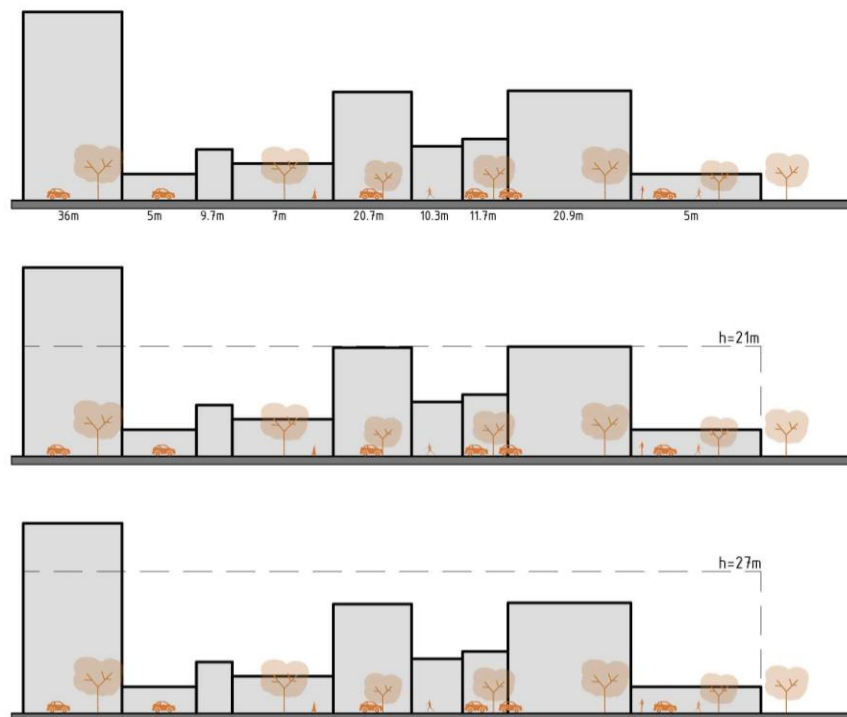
Vistas 1 do terreno analisado para as fachadas da Avenida Henrique Valadares.
